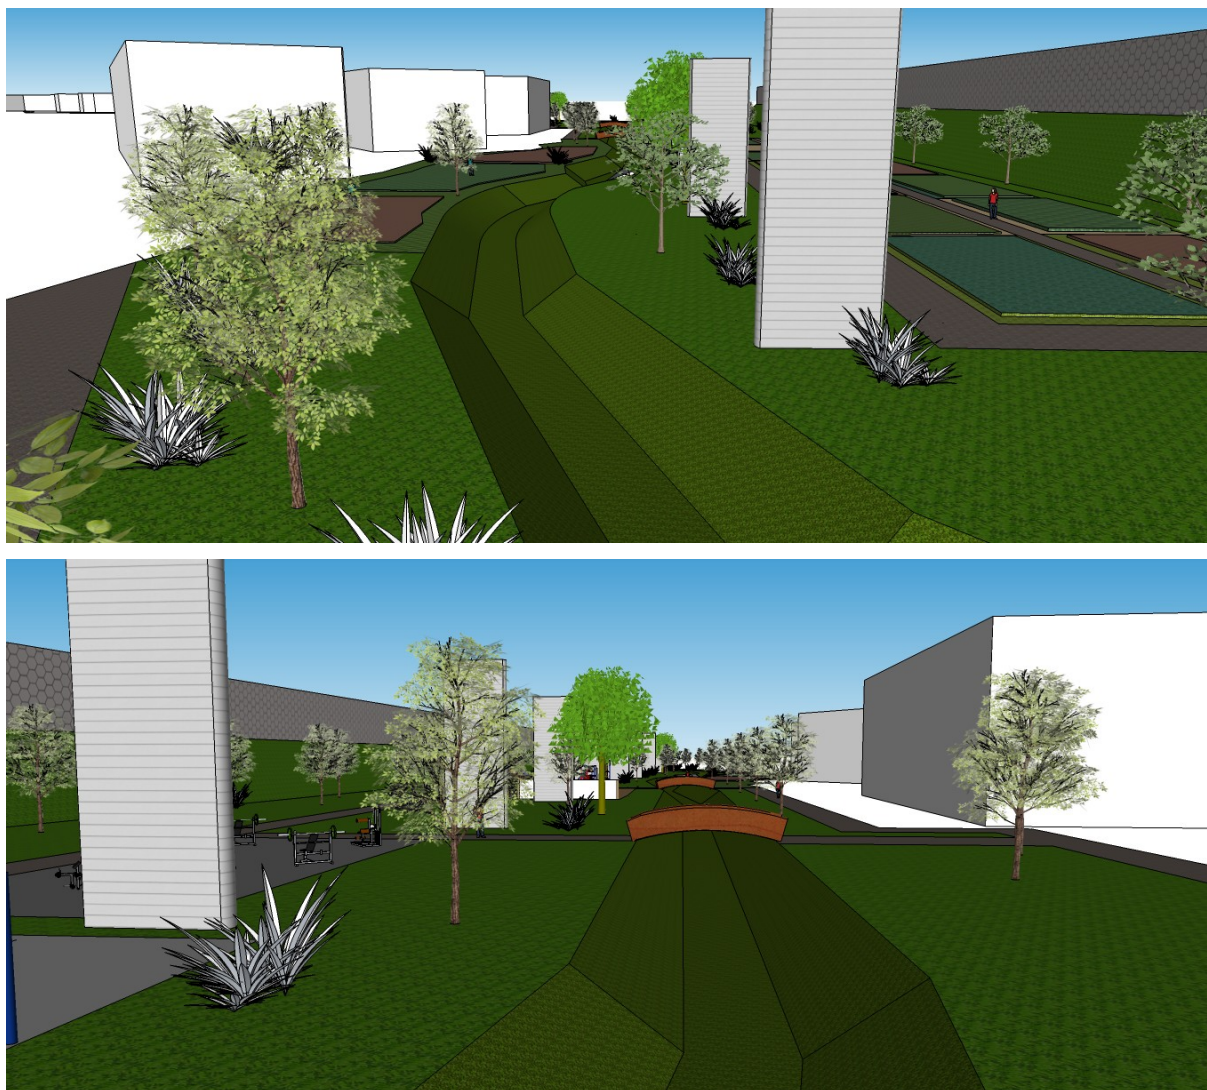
Vista transversal do Troço 1 após a requalificação: início do troço (acima) e fim do troço (abaixo)
